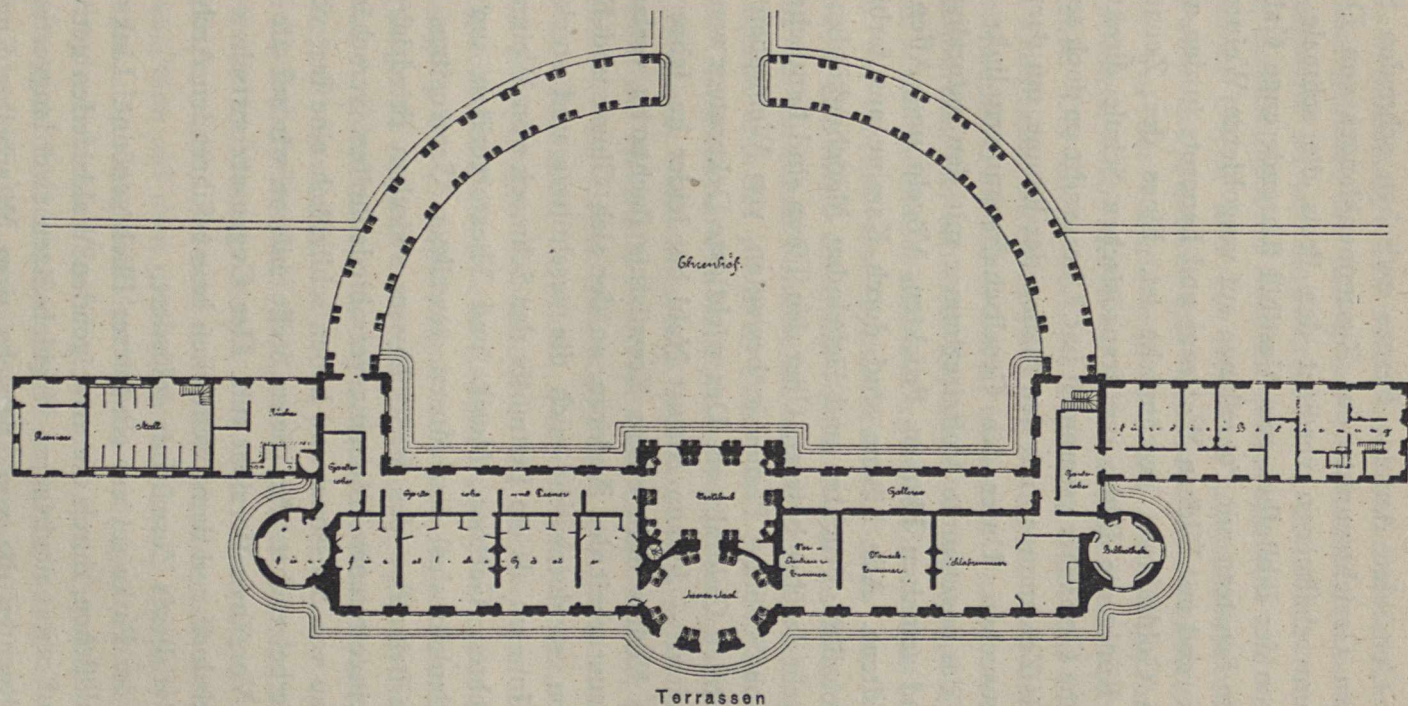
Sanssouci, Grundriß des Erdgeschosses (nach Geyer)
